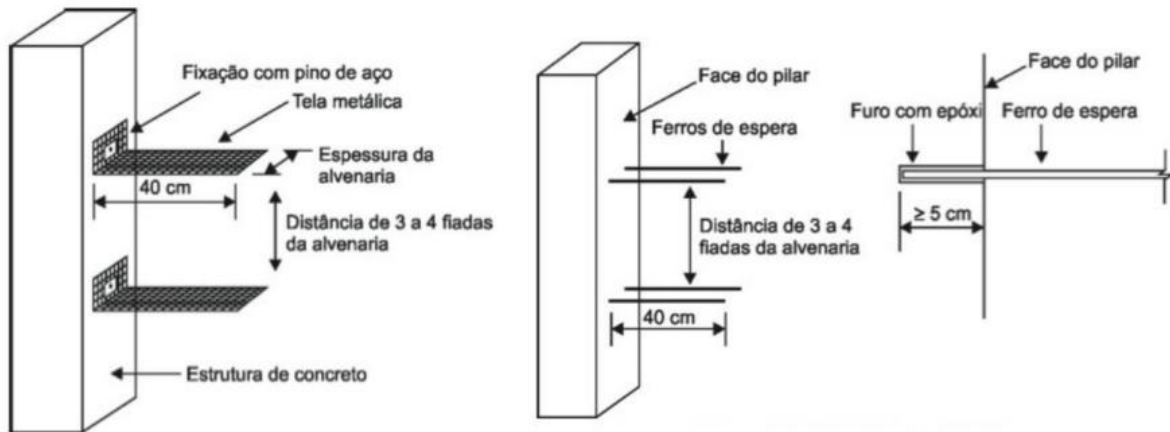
Amarrações de alvenaria (Fonte: BARBOSA, 2019)
